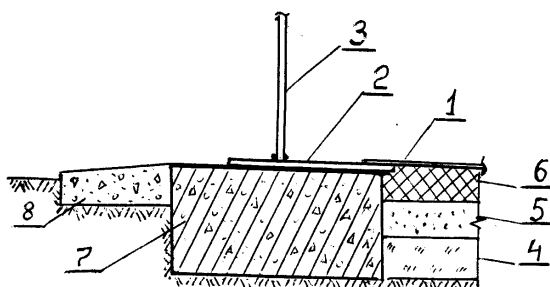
Фрагмент основания, усиленного железобетонным кольцом:
